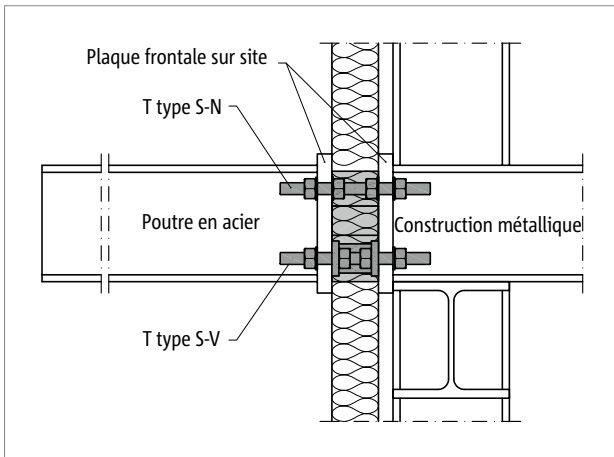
Schöck Isokorb® T type S-N et T type S-V : construction en acier en porte-à-faux libre
